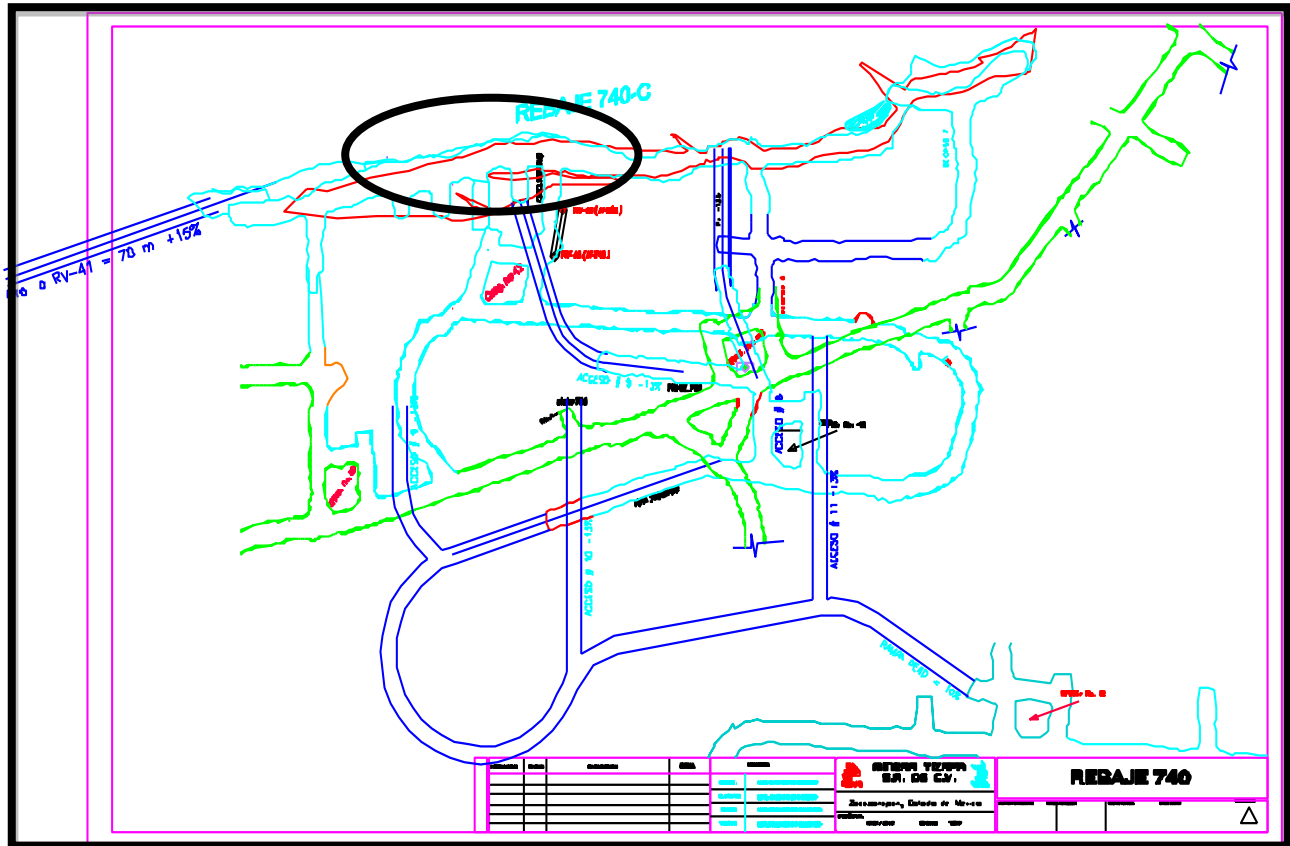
Área de recuperación de pilares en rebaje 740 centro
